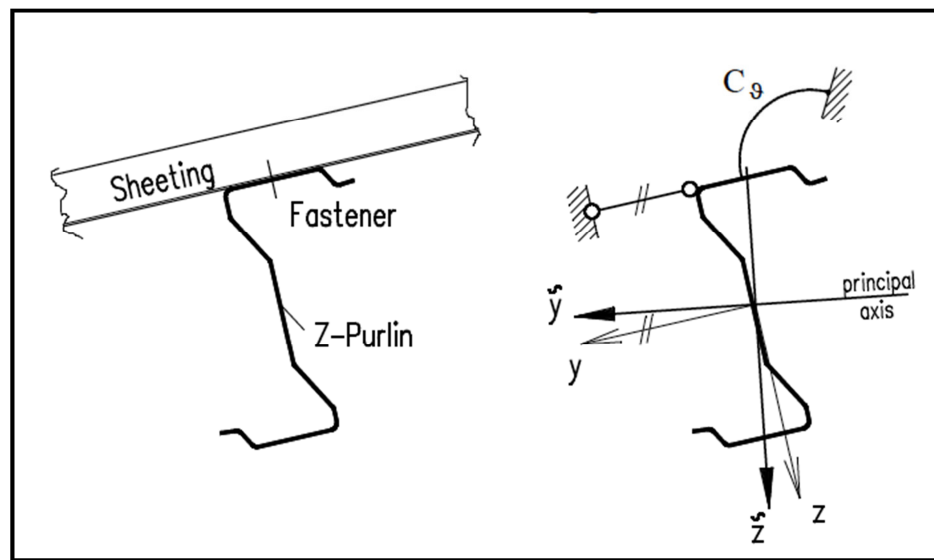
Arcareccio a Z: sistema reale e schema statico secondo l'EC3-1-3
